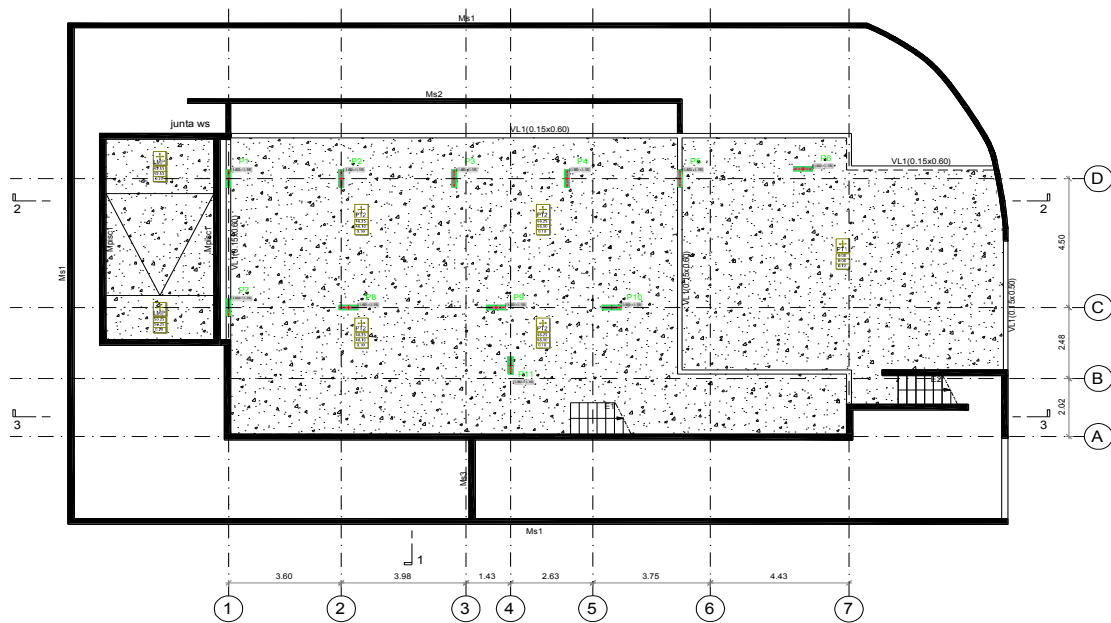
PLANTA ESTRUTURAL DE FUNDAÇÕES (AUTOCAD)
